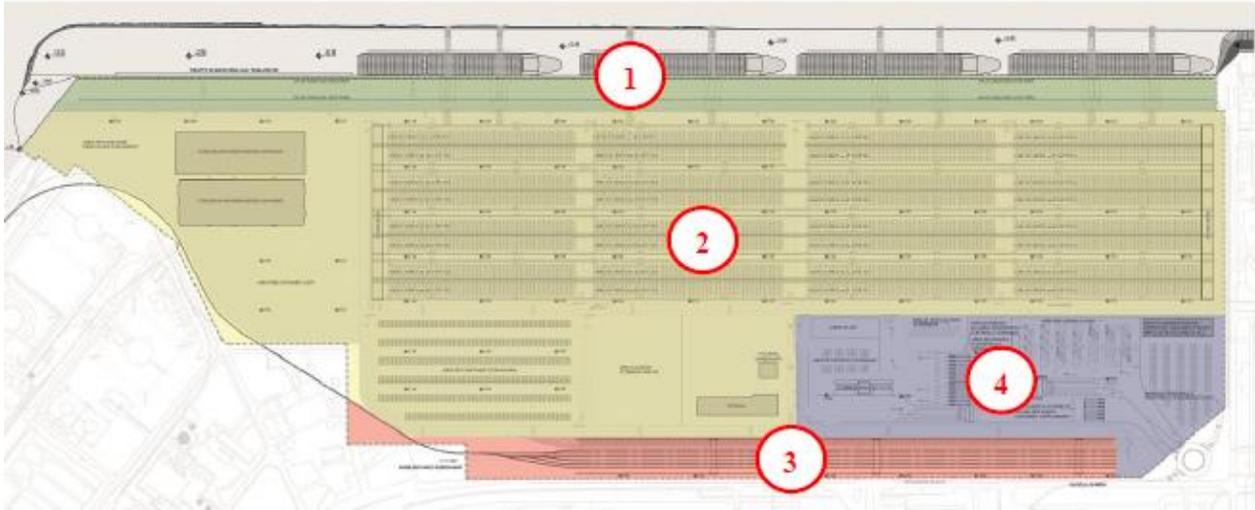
Layout progettuale del nuovo progetto in fase di valutazione - Terminal Onshore
